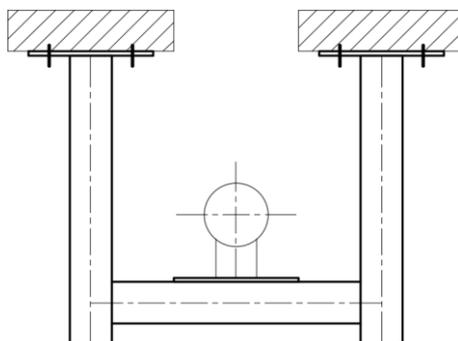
Подпорная конструкция – П-образная конструкция.
